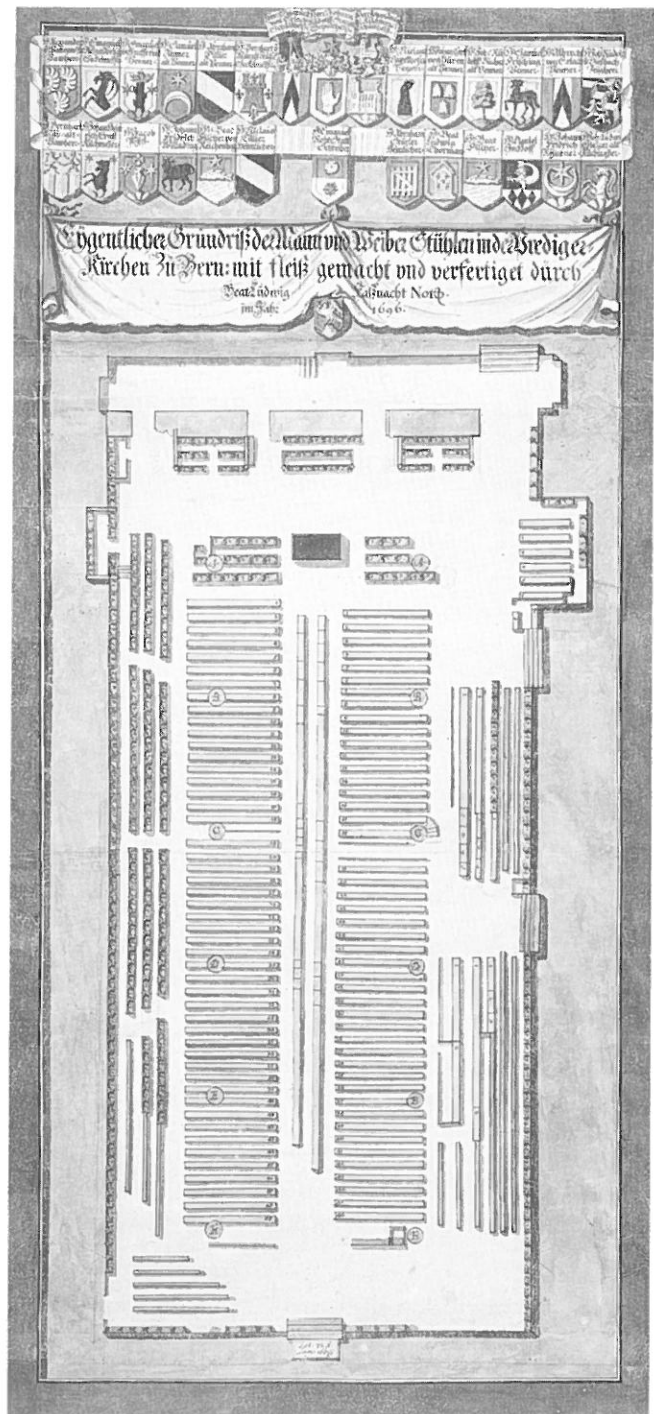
Französische Kirche. Bestuhlungsplan des Langhauses von Beat Ludwig Fasnacht aus dem Jahre 1696. Dargestellt ist der Inngrundriss des Langhauses vor der im 18. Jahrhundert erfolgten Verkürzung um ein Joch inklusive der südlichen Seitenkapelle. Auffallend ist die dichte Bestuhlung, welche sich sogar in ehemalige Lettnerkapellen hineinzieht.
